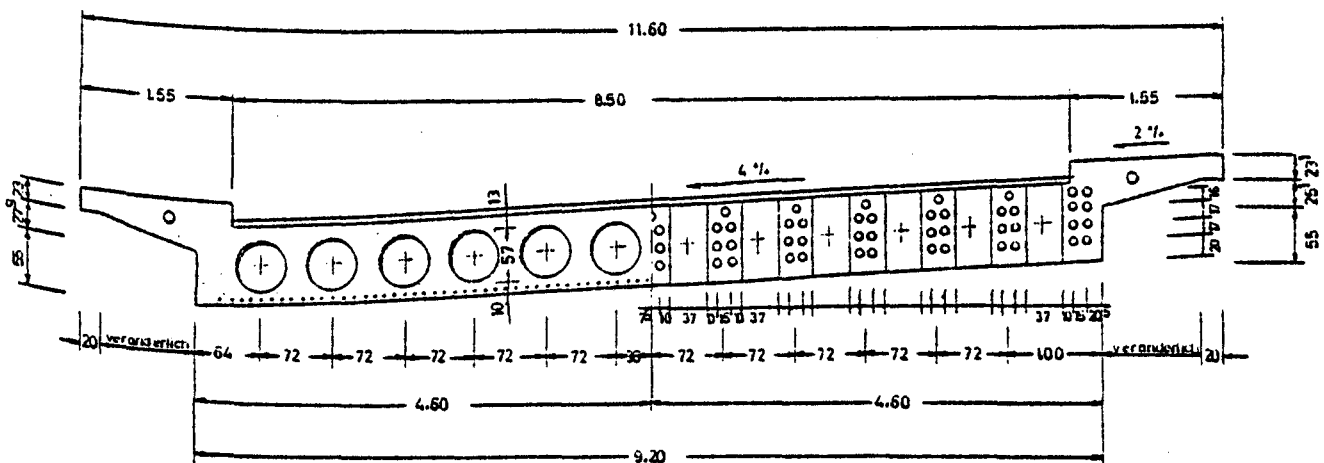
Konstruktion der Spannbetonbrücke über die Brachtpe
